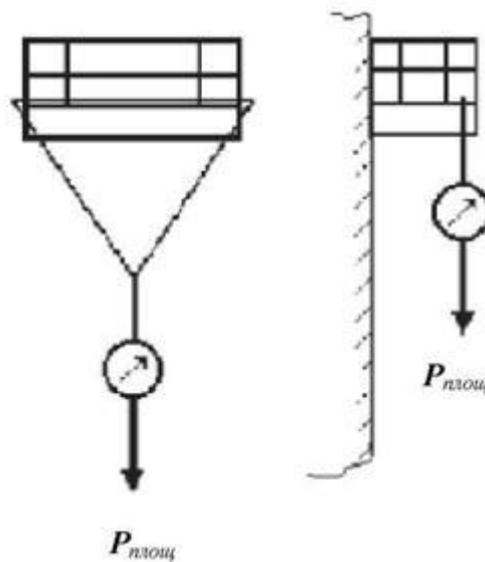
Схема приложения испытательной нагрузки для площадки лестницы
